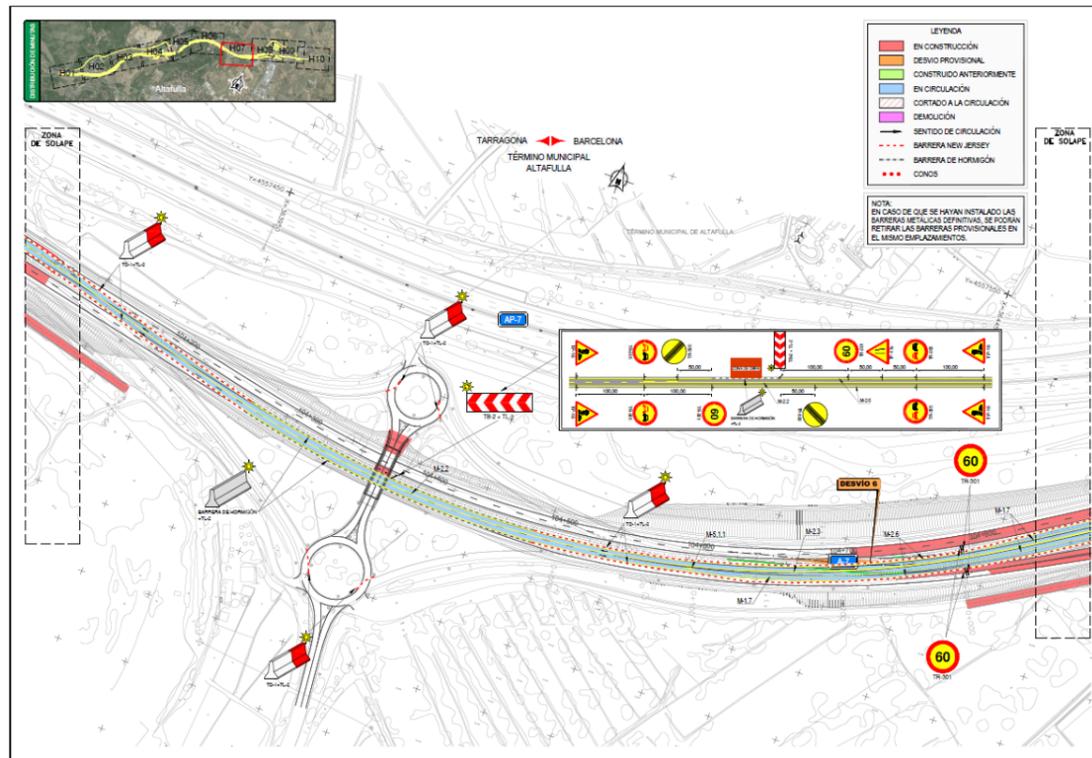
Subfase 2B. Ejecución de la zapata de cimentación de la pila y del nuevo estribo Norte
